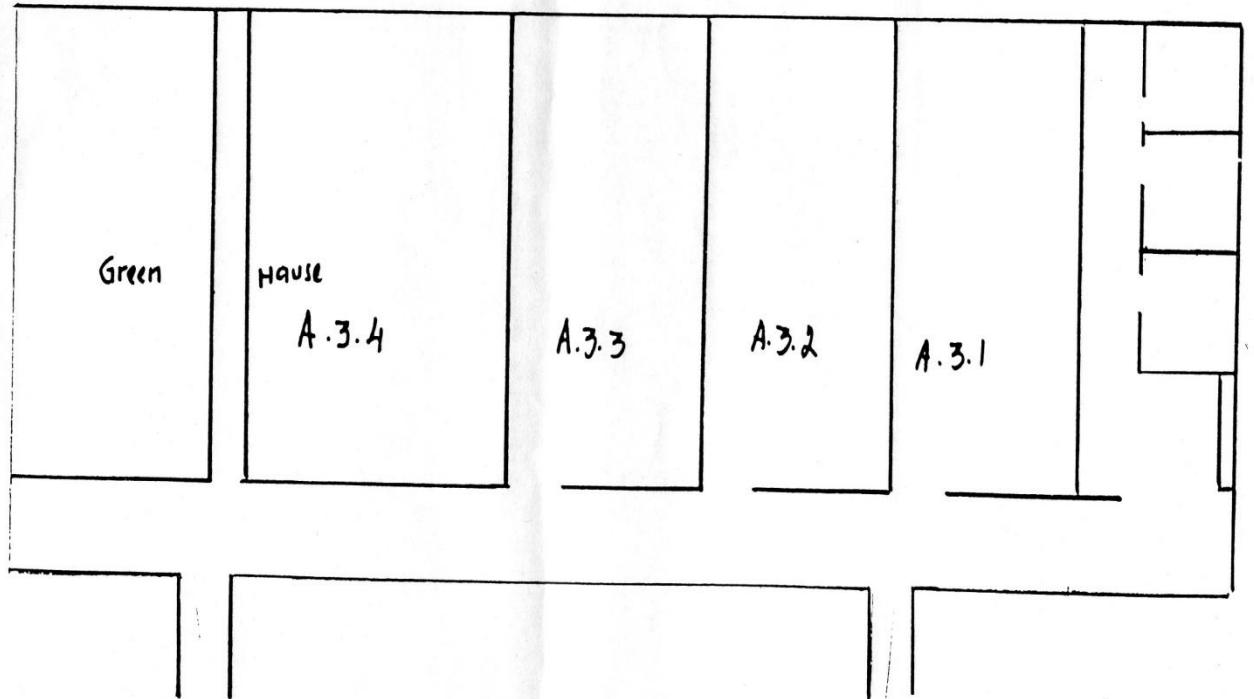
Denah Lantai 1 SMA Negeri 1 Malang (Lokal Bawah)
